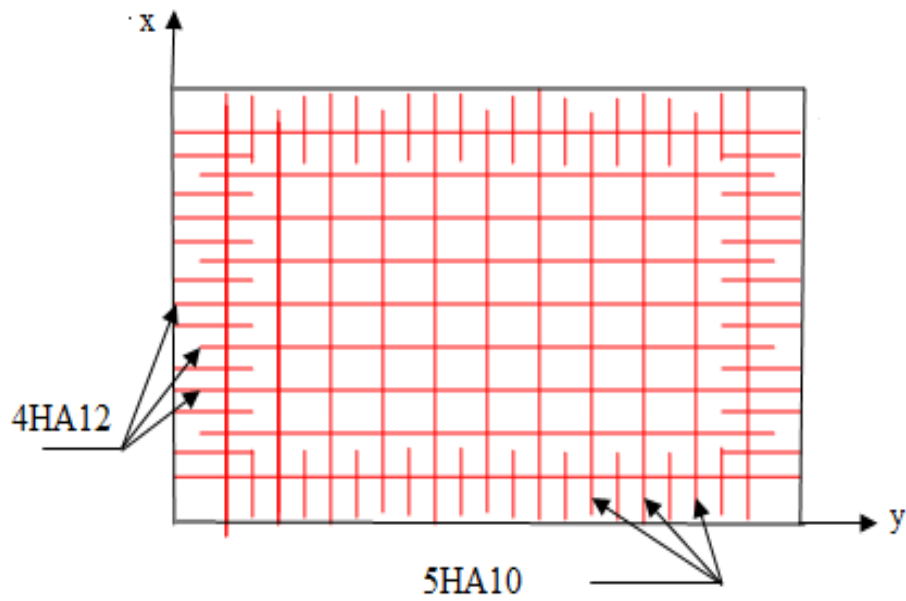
Schéma de ferrailage de la dalle supérieure.
